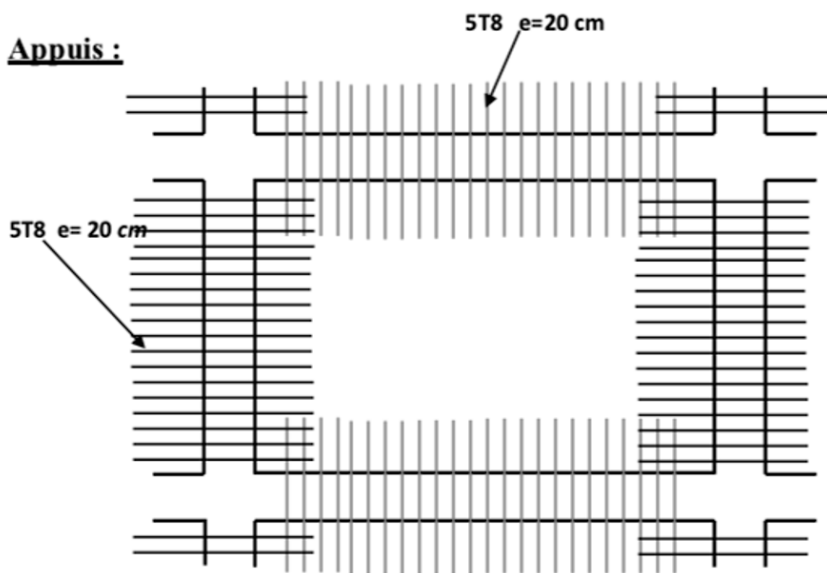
Croquis du ferrailage panneau dalle
